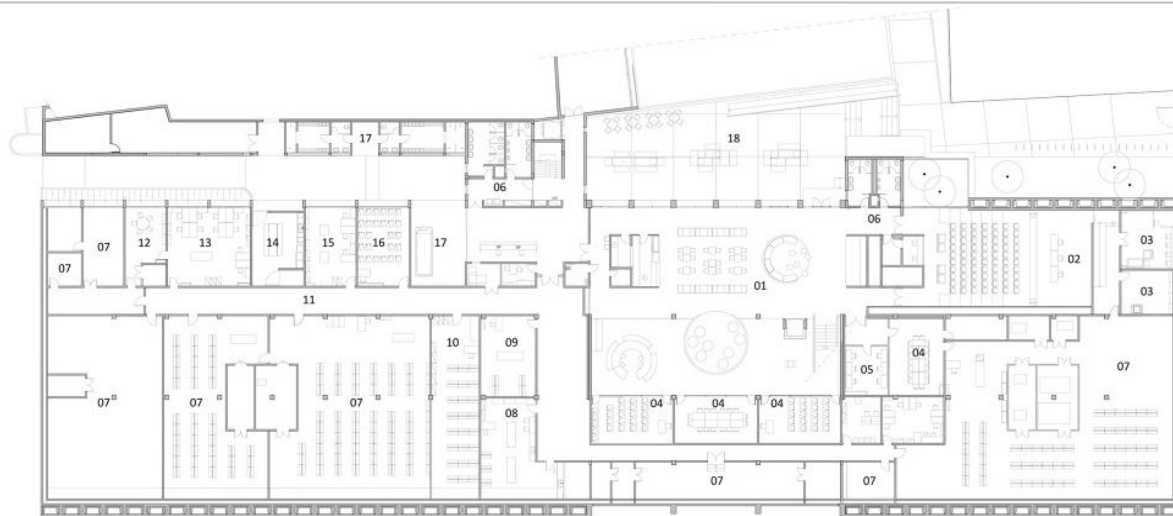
Planta baixa pav. inferior Biblioteca Estadual Rio de Janeiro. Fonte: Studio Chao (2019).
